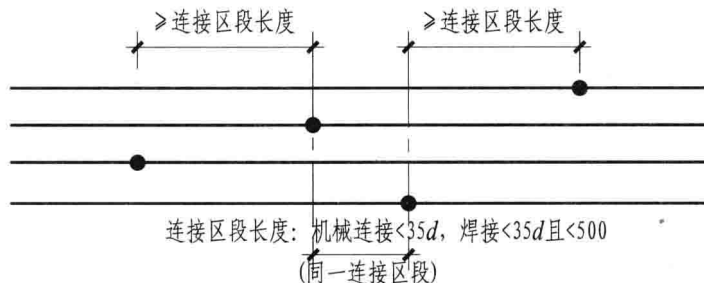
同一连接区段内纵向受拉钢筋机械连接、焊接接头
